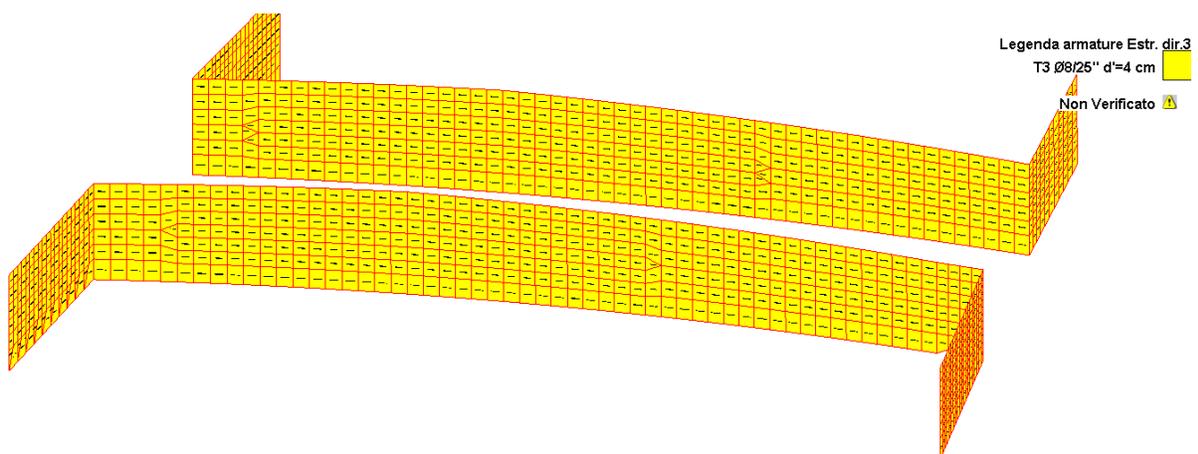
Armatura fusto Spalla di Estradosso ed Intradosso direzione 3
